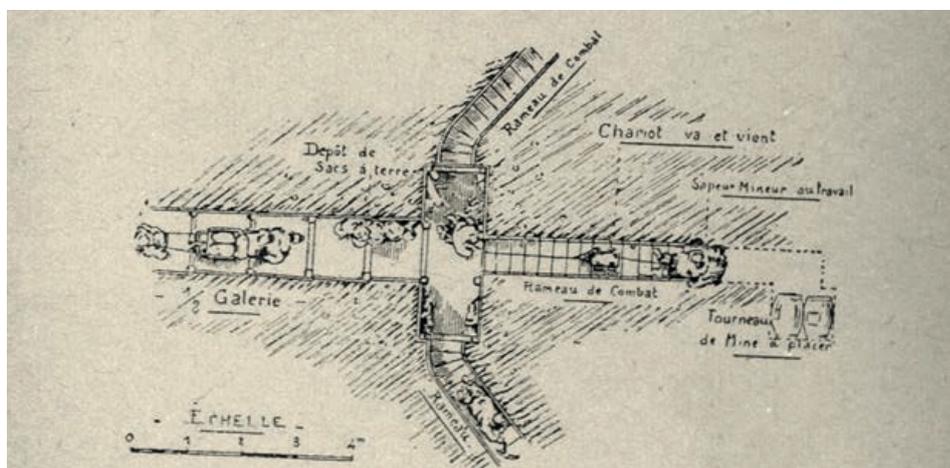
Travail de mine : départ en trois rameaux au fond d'une demi-galerie, en plan.
